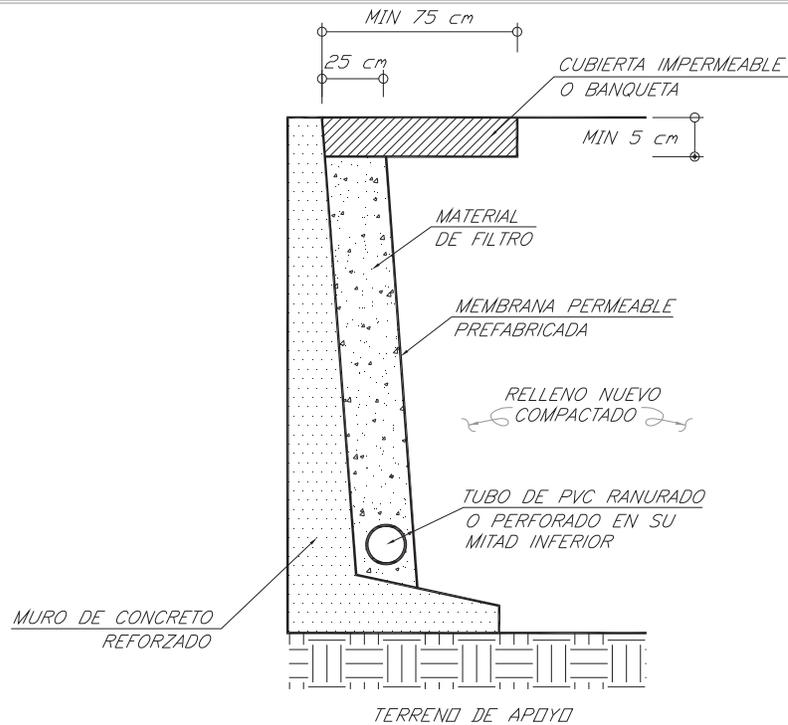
Sistema de drenaje en muros de contención.
